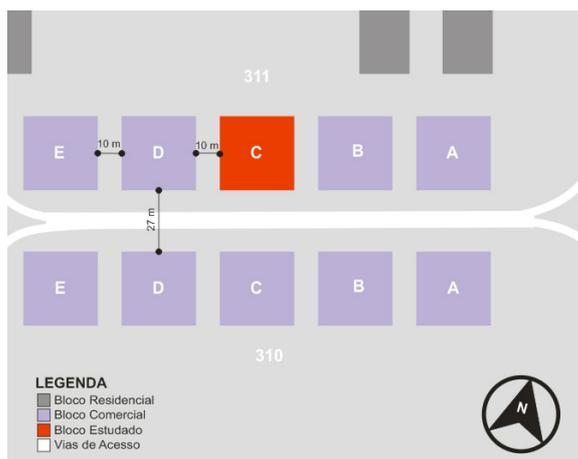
Planta de Situação da Amostra A (CLN 311 Bloco C)
